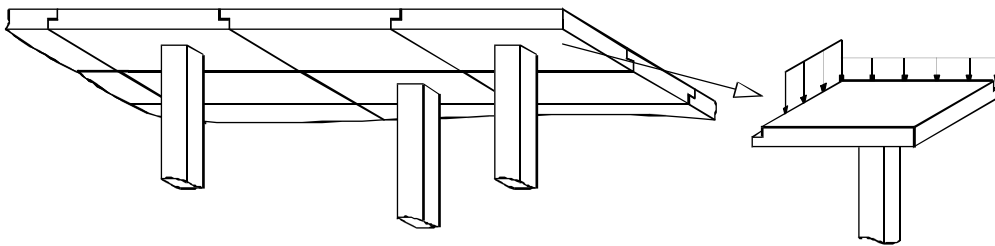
Gestützte Geschoßdecke mit Berechnungssegment
